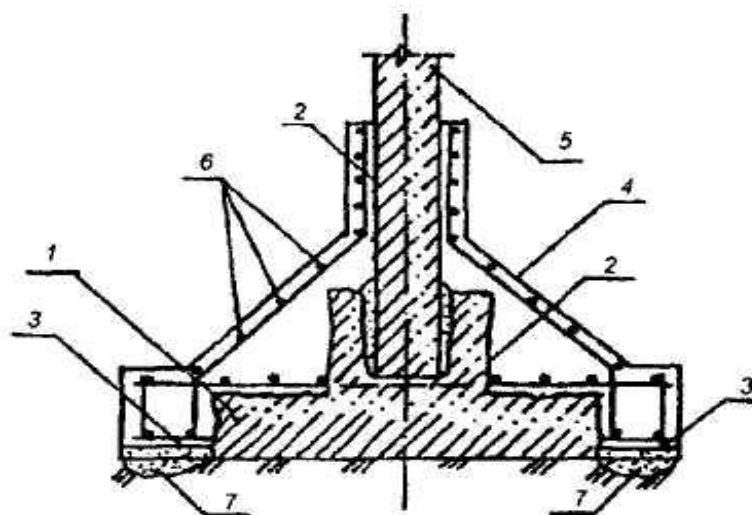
Уширение подошвы для отдельного фундамента (устройство железобетонной рубашки)
